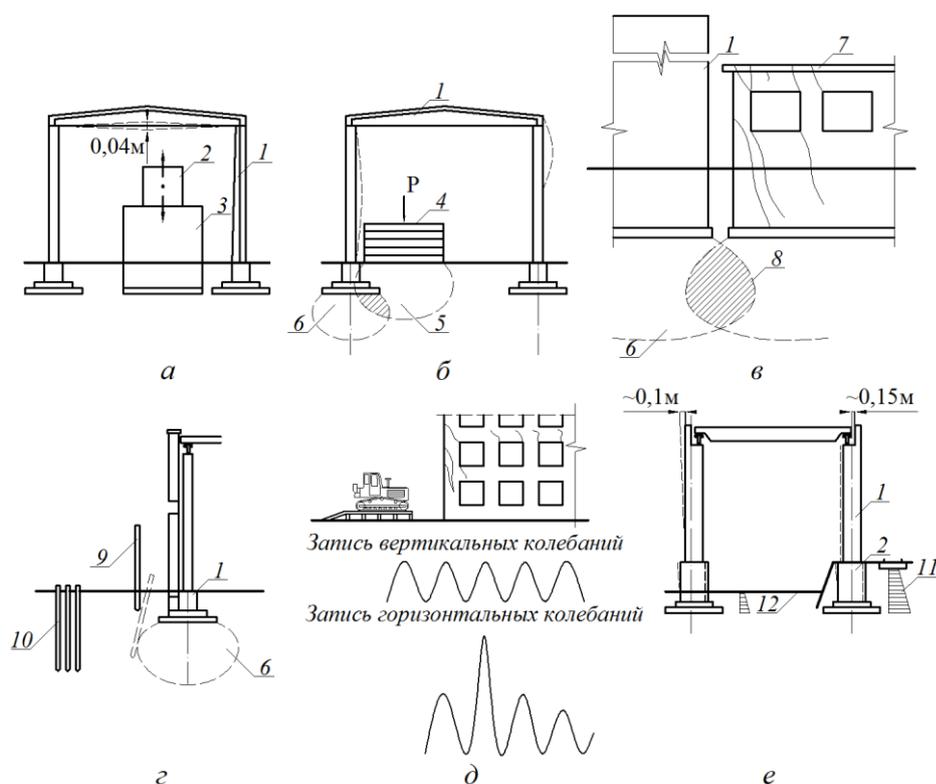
Неучет отдельных воздействий при эксплуатации здания при разработке его проекта: а – динамическое воздействие оборудования через грунт и фундамент на здание; б – действие пригруза; в – влияние построенного рядом здания; г – затруднения в погружении свай рядом с ранее построенным зданием; д – воздействие вибрации от машин; е – действие бокового давления грунта на фундаменты; 1 – здание; 2 – оборудование; 3 – фундамент; 4 – пригруз; 5 – уплотненная зона под пригрузом; 6 – уплотненная зона под фундаментом; 7 – ранее построенное здание; 8 – наложение напряженных зон; 9 – сваи, забиваемые рядом с фундаментами здания; 10 – сваи, забиваемые на удалении от фундаментов здания; 11 – боковое давление грунта; 12 – приямок
